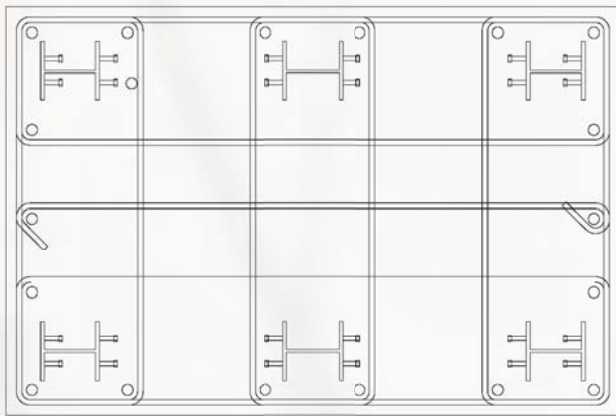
鋼與混凝土複合式橋柱剪力釘之斷面配置
